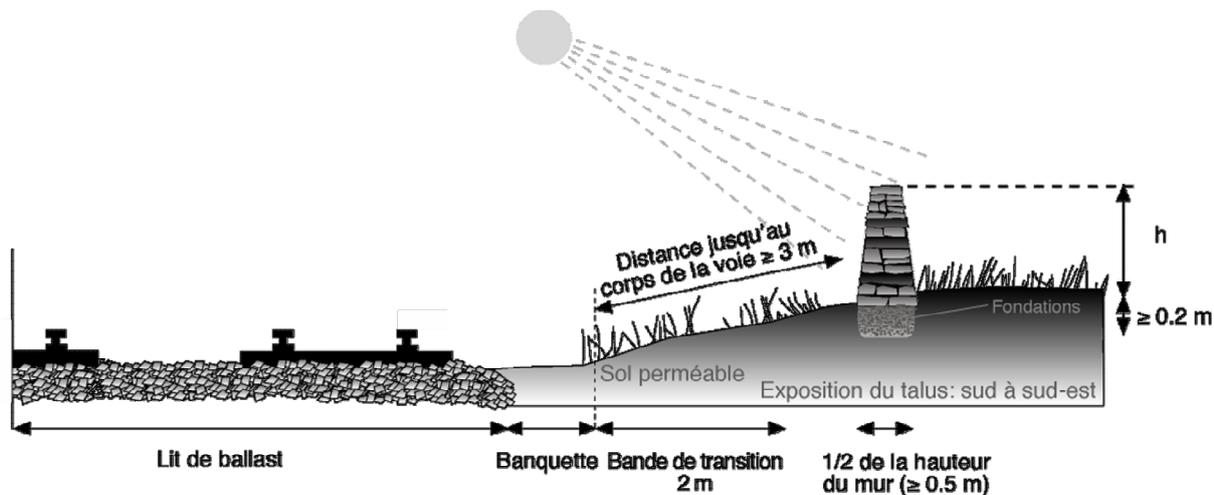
coupe transversale d'un mur de pierres sèches (sans fonction de soutènement).
